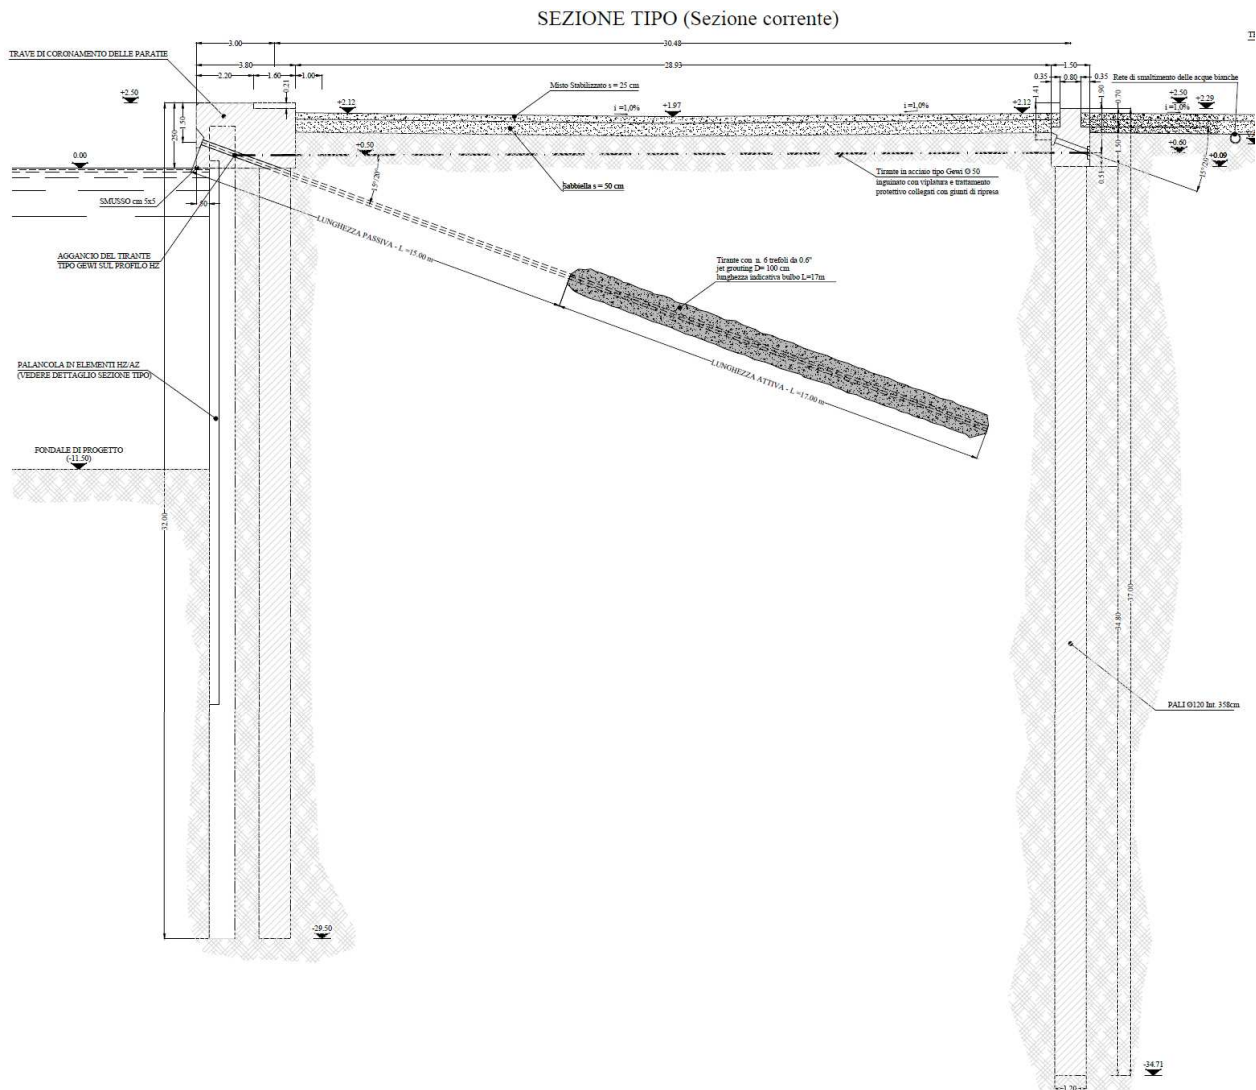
Stato di fatto - Sezione corrente (Estratto dalla 2ª Perizia di Variante – Sezioni Tipologiche: Tiranti con Jet Grouting)
